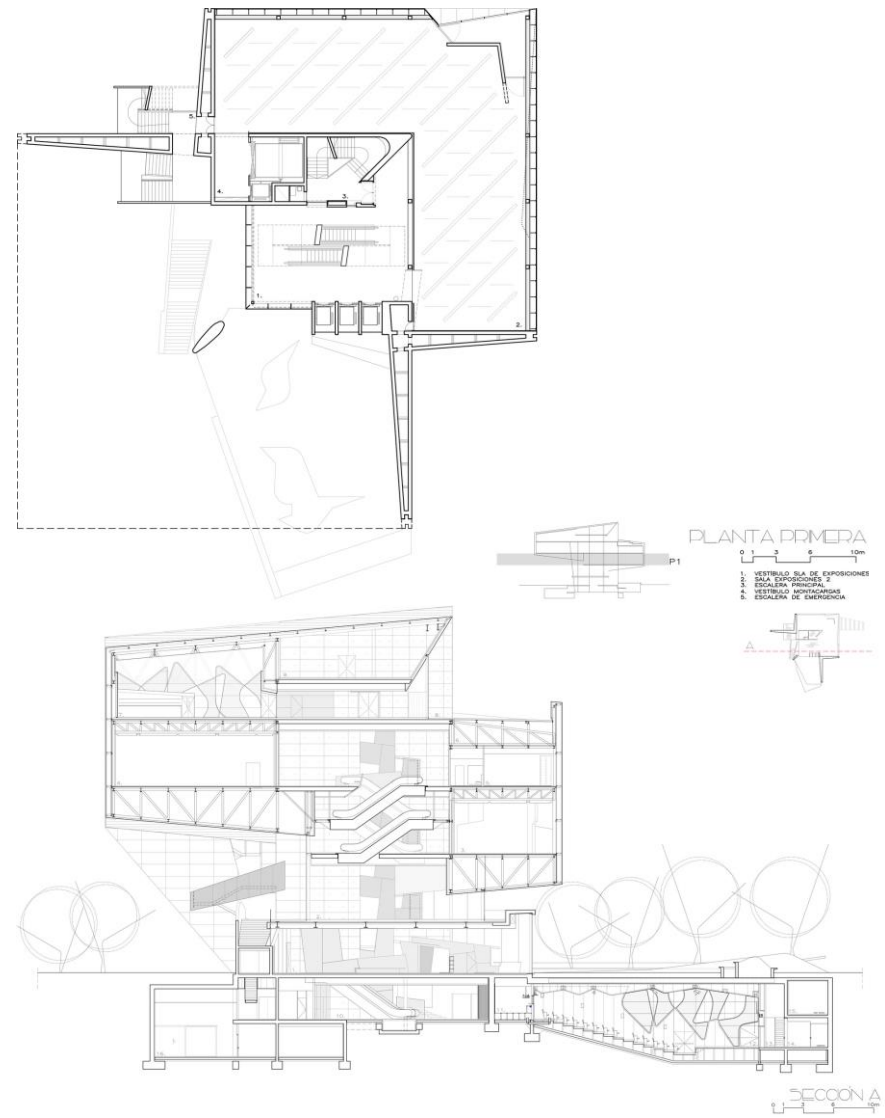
(Sup) Planta primera. Imagen (Inf) 2.20 Sección A.
